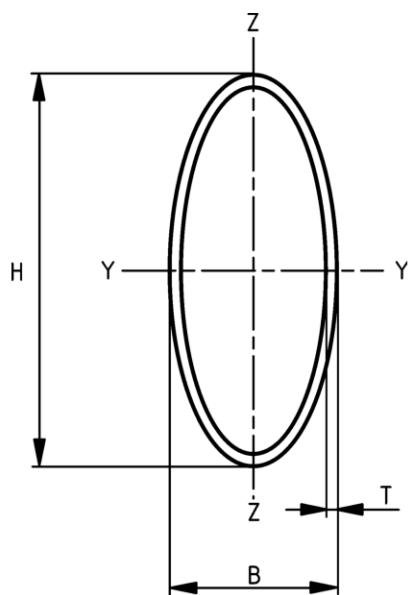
Hohlprofil mit elliptischem Querschnitt
